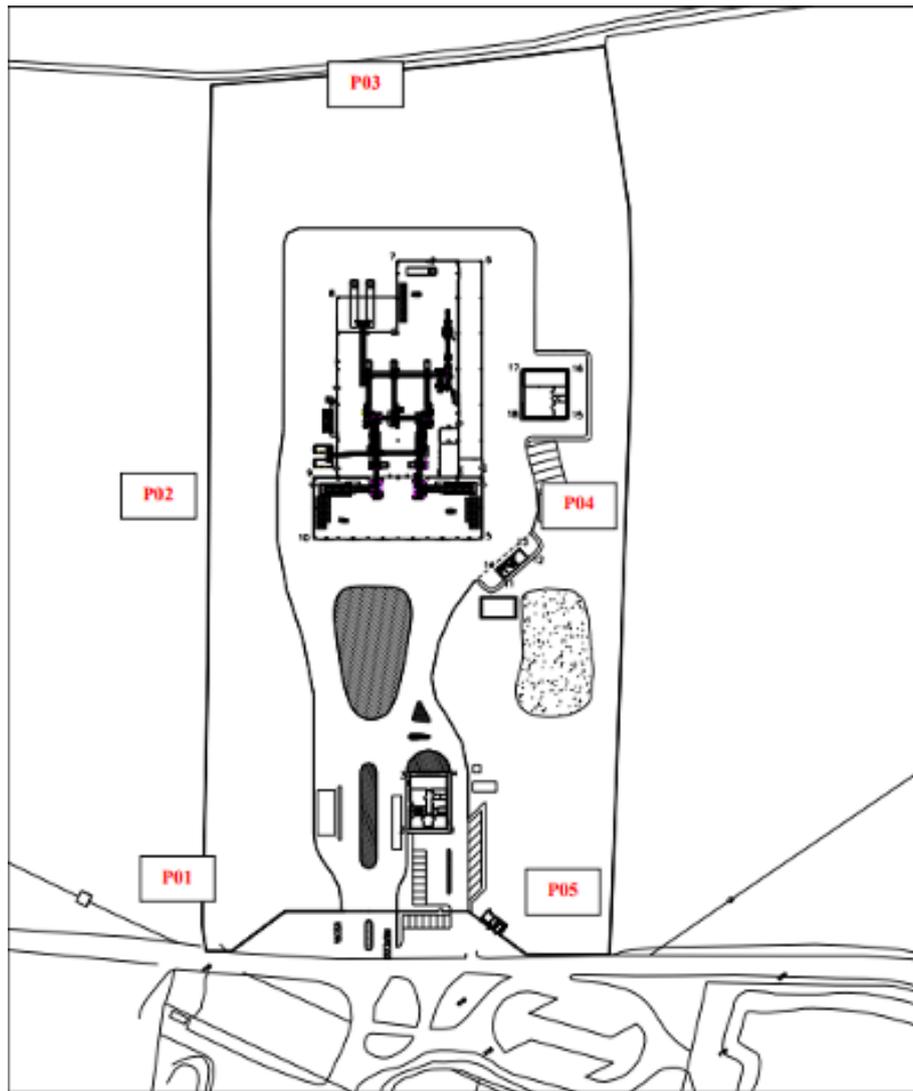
Planimetria Insedimento - rilievi fonometrici
